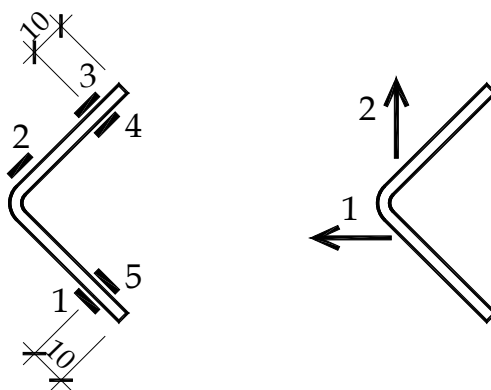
Posição dos extensômetros e transdutores de deslocamento: perfil L 60x2,25: barras tipos I e II (dimensões em mm)
